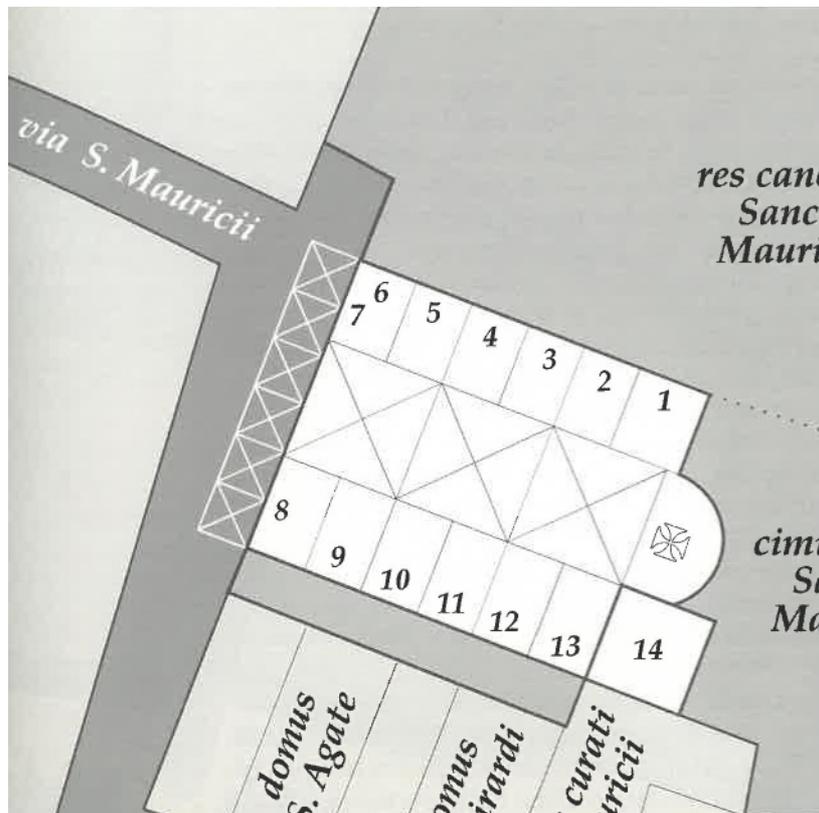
Pianta Chiesa di San Maurizio nel 1428
